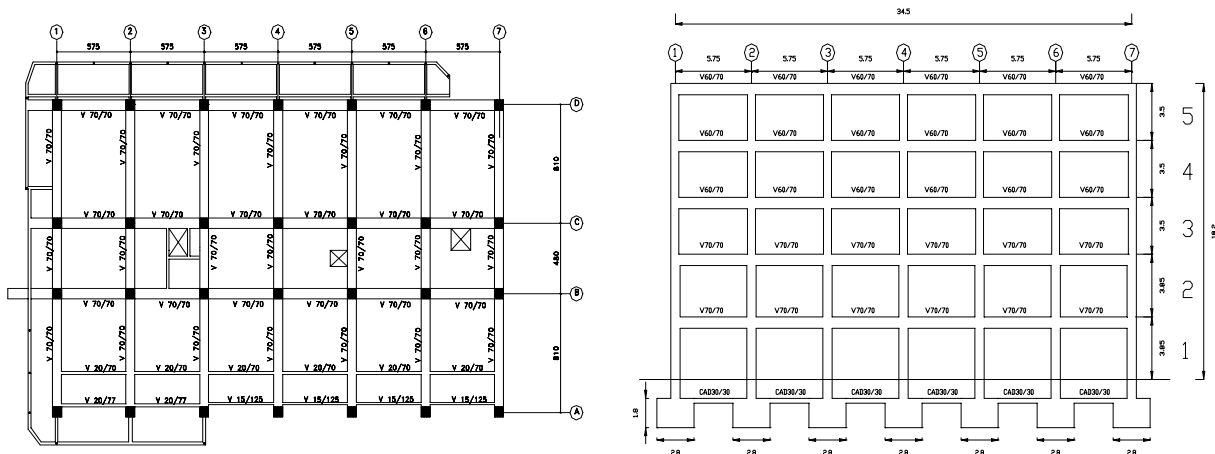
PLANTA Y ELEVACIÓN DE UN EJE LONGITUDINAL DEL EDIFICIO DE MARCOS
